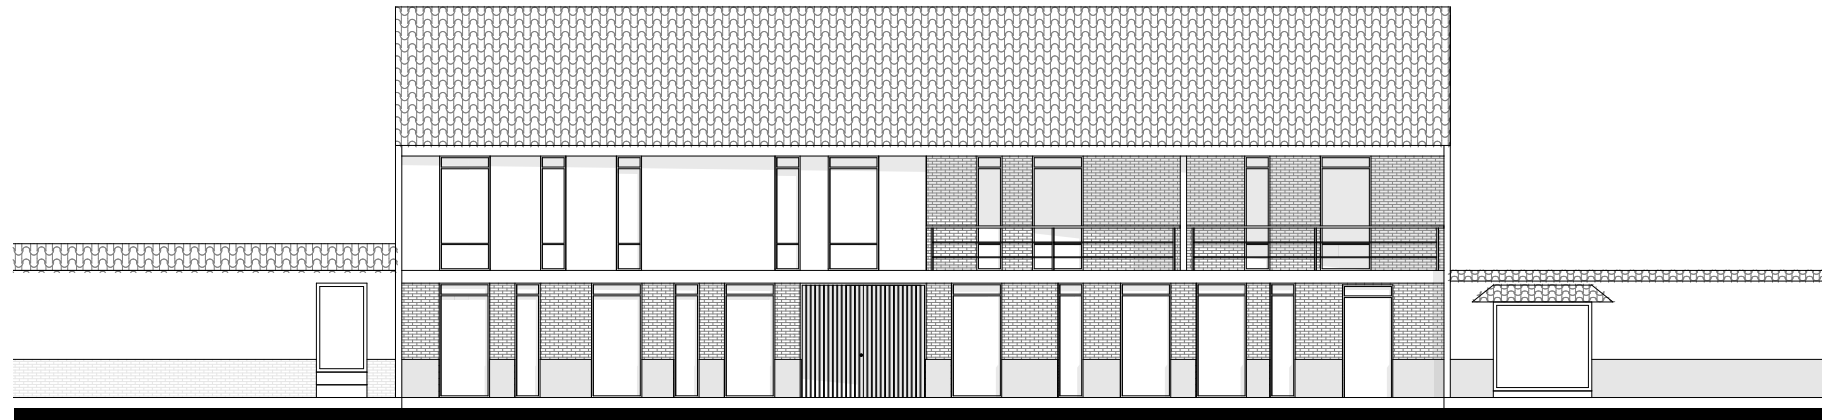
Elevación. Elaborado por Grupo de Tesis.
